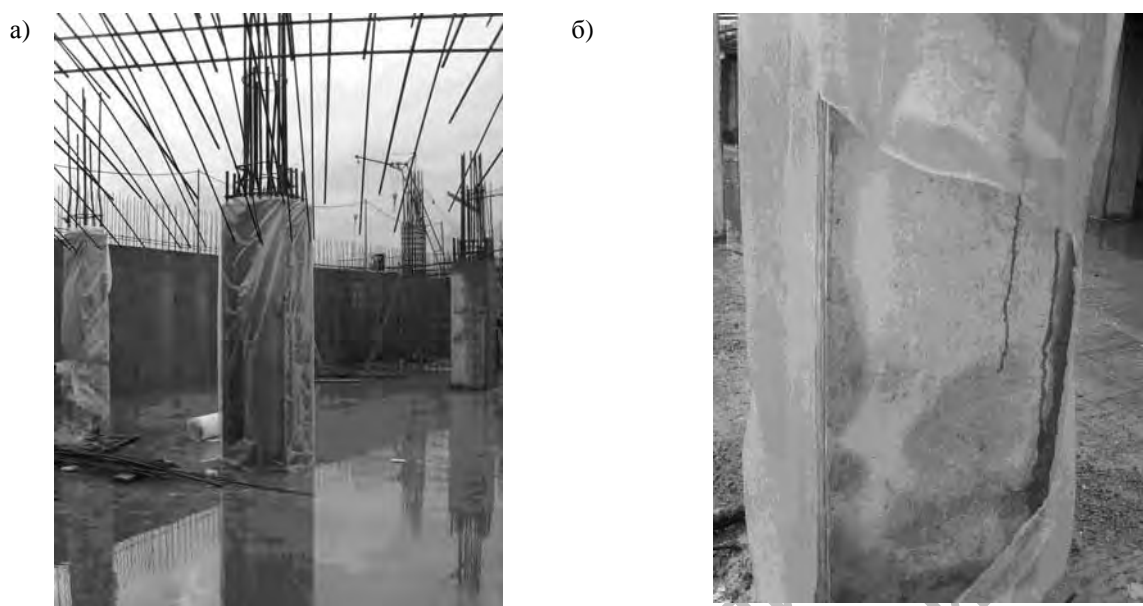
Уход за бетоном колонн путем укрытия ее полиэтиленовой пленкой: а – укрытие пленкой бетона в возрасте 2 сут после распалубливания; б – из-за воздействия ветра пленка порвалась, визуально открытые углы колонны имеют признаки обезвоживания бетона
